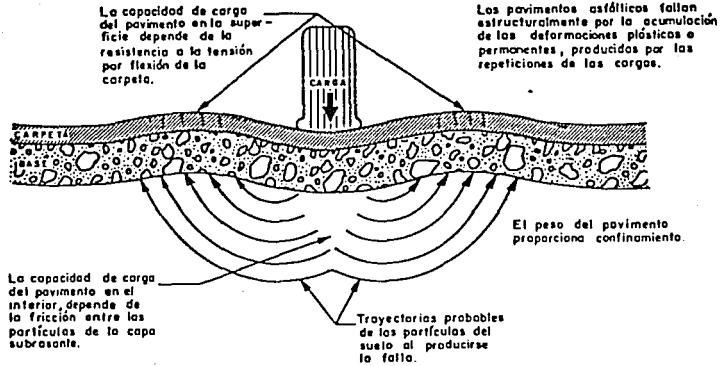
Modelo de falla estructural de un pavimento asfáltico (Ref. 2)
